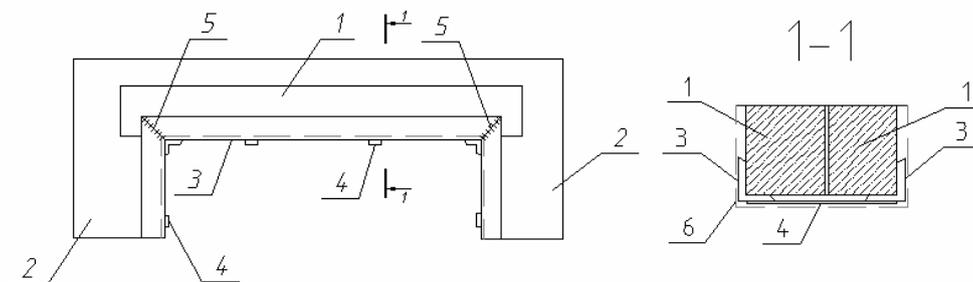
Усиление перемычек подведением разгружающих рам из прокатного металла: 1 – усиливаемые перемычки; 2 – кирпичные простенки; 3 – разгружающая рама в виде обрамления проема из уголка (устанавливается на цементно-песчаном растворе); 4 – поперечные планки на сварке; 5 – сварка уголков обрамления; 6 – штукатурка по сетке
